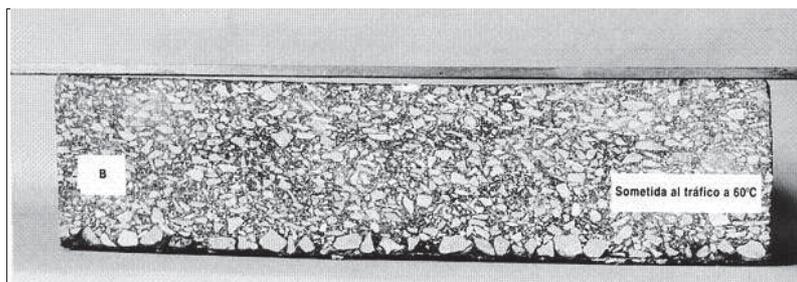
Muestra de Pavimento Asfáltico Modificado
